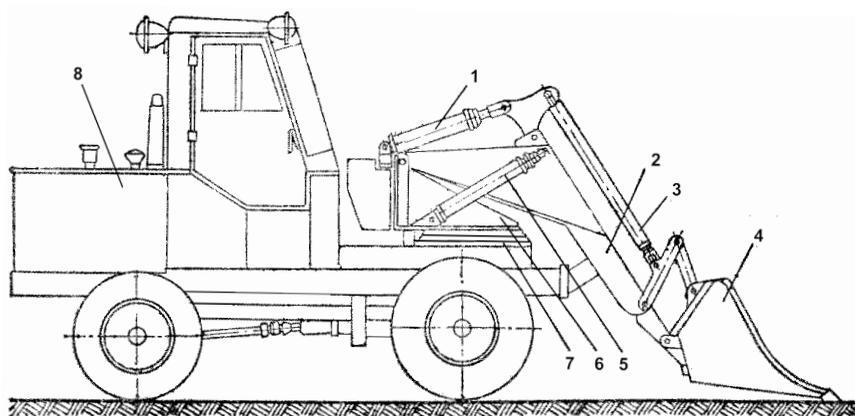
Полуповоротный одноковшовый погрузчик:
